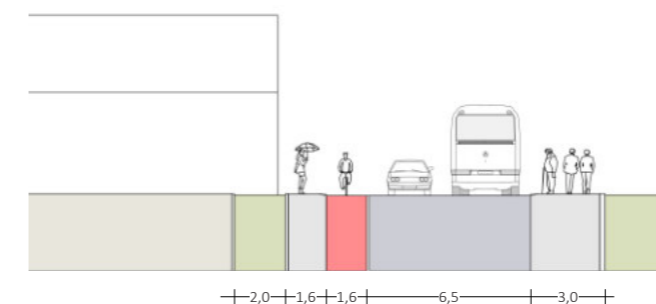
Bayreuther Straße, Schnitt Vorschlag zur Abstimmung mit dem Kreis
